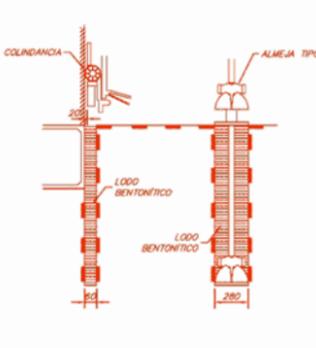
GEOMETRÍA DE LA EXCAVACIÓN Y ESTABILIDAD DE LA ZANJA
